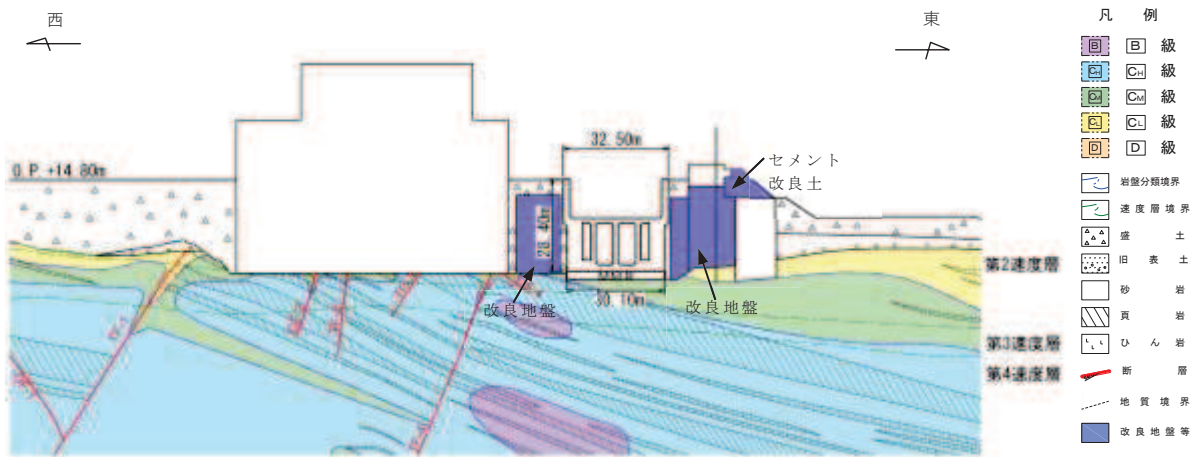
海水ポンプ室の地質断面図 (⑭-⑭断面)
